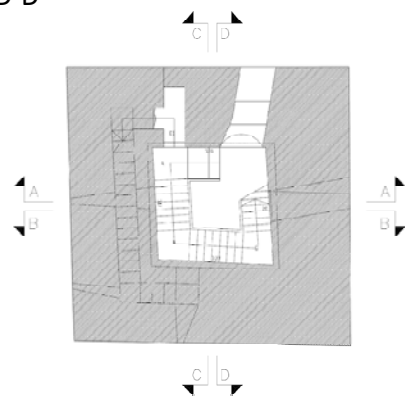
secciones de la torre de Sinlabajos. Estado actual.
